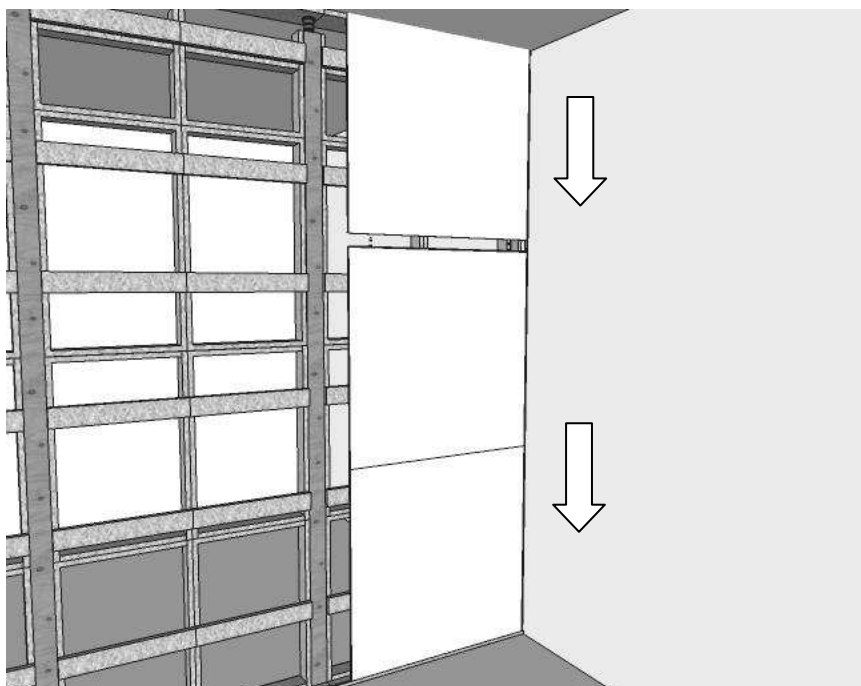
Colocação primeira placa de MDF e fixação por fecho metálico na parte posterior.
